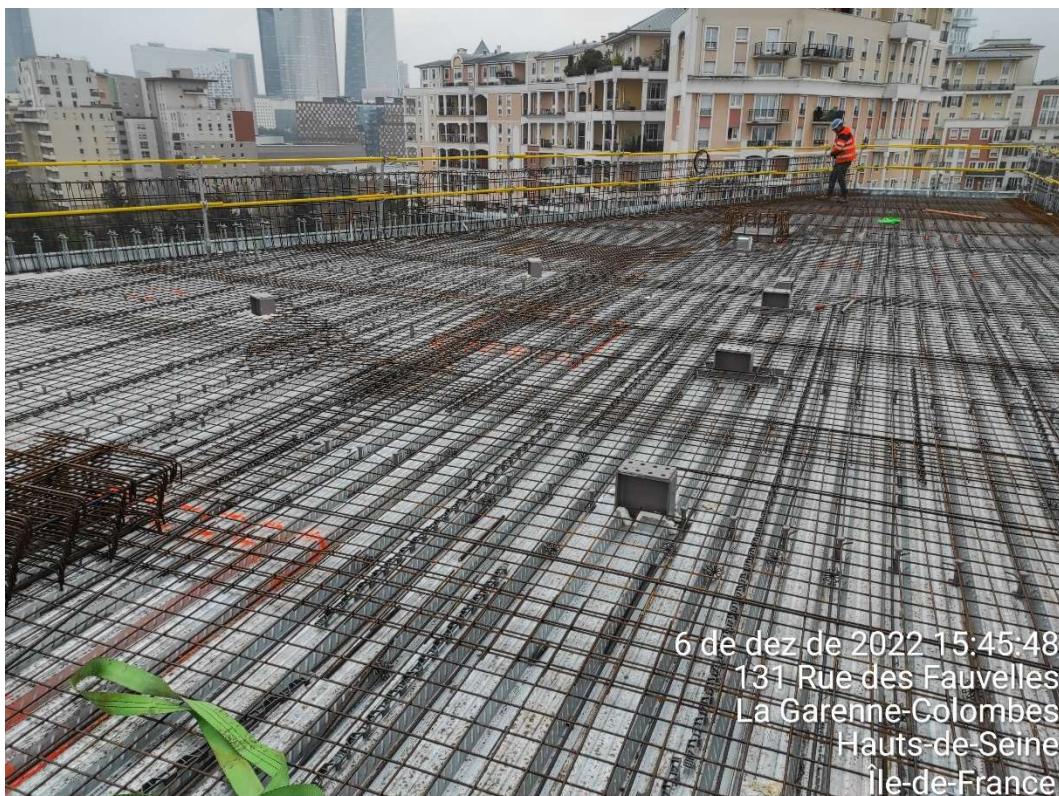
Suporte do pilar da casa de máquinas (Fonte: Autor)
